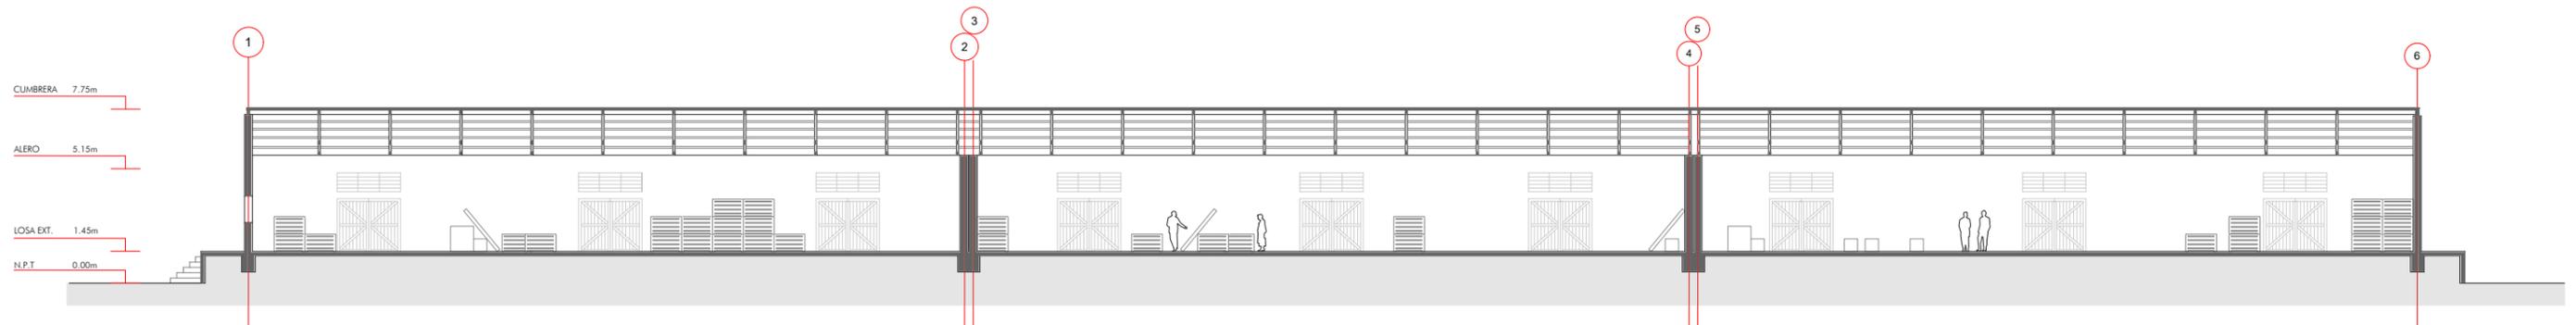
Elevaciones laterales y corte transversal ex Bodega Elaboración propia.
